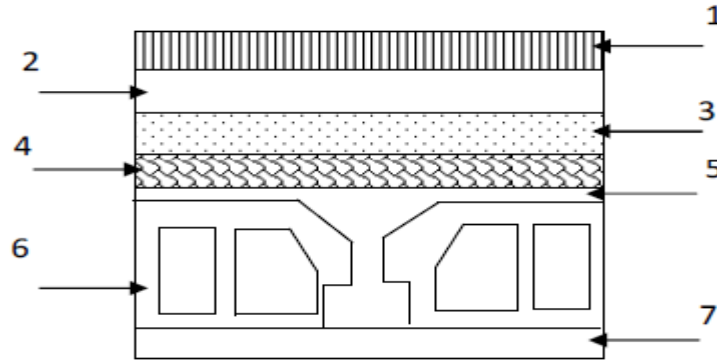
Coupe transversale du plancher terrasse inaccessible
